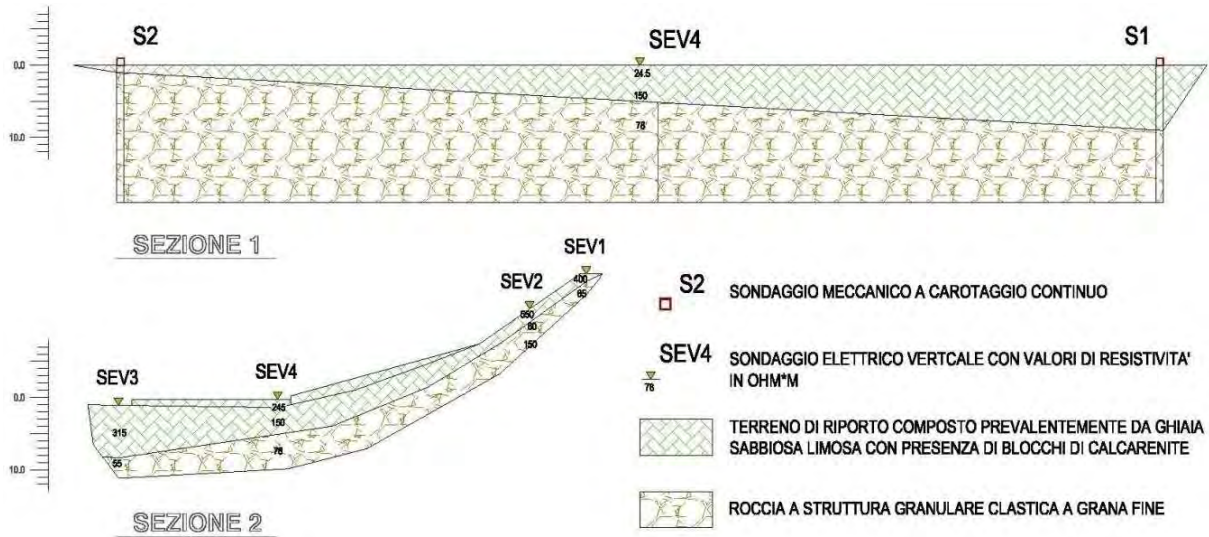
Sezioni elettrostratigrafiche in riferimento alla planimetria di Fig. 4.1
